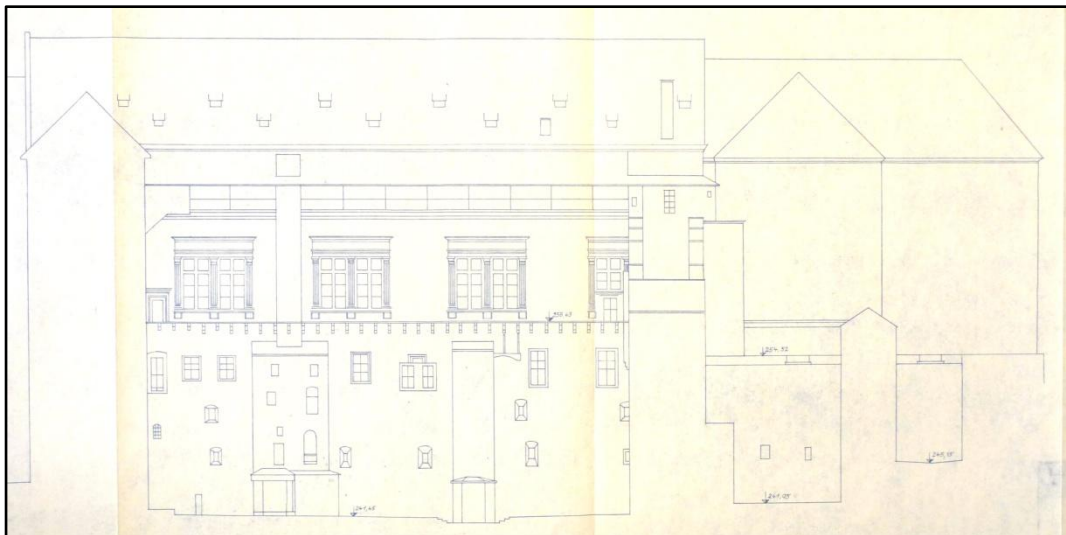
prospetto Sud del corpo centrale, scala 1:200 (da Archivio Storico, 1964)
